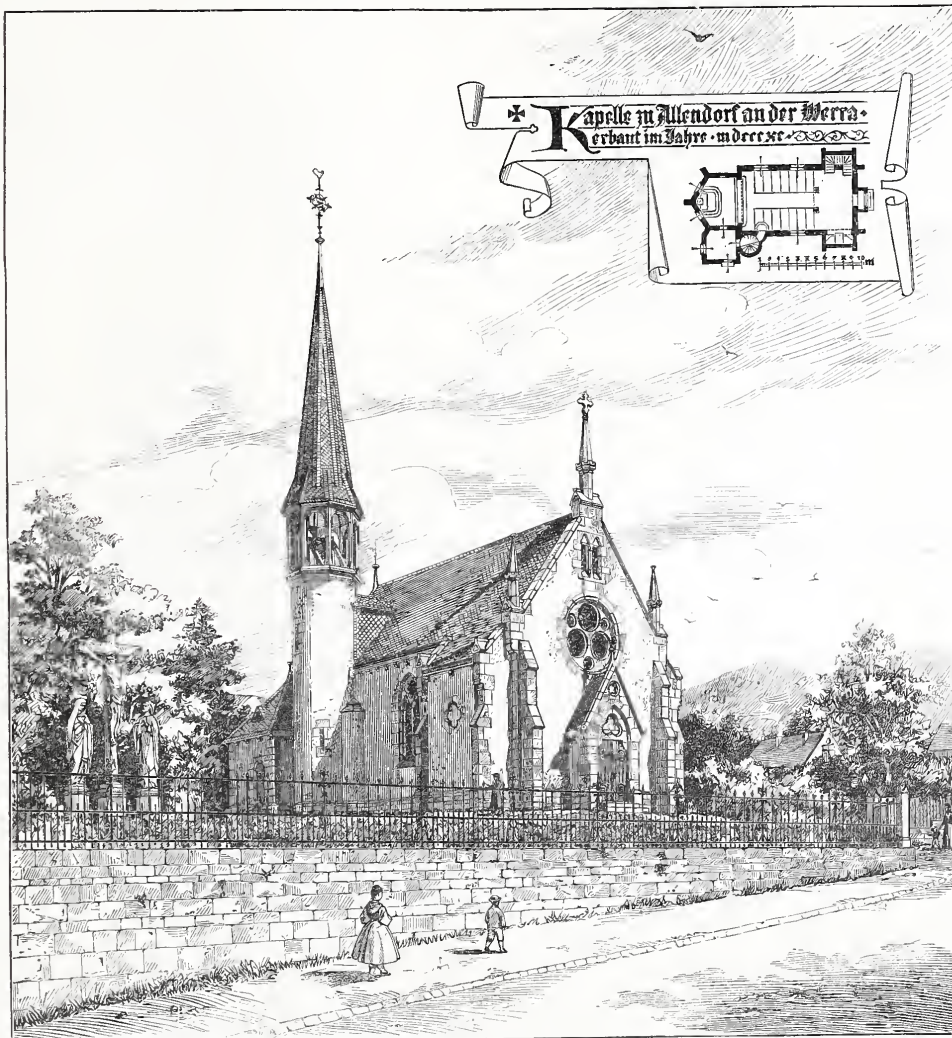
Ansicht und Grundriss zu ebener Erde.
